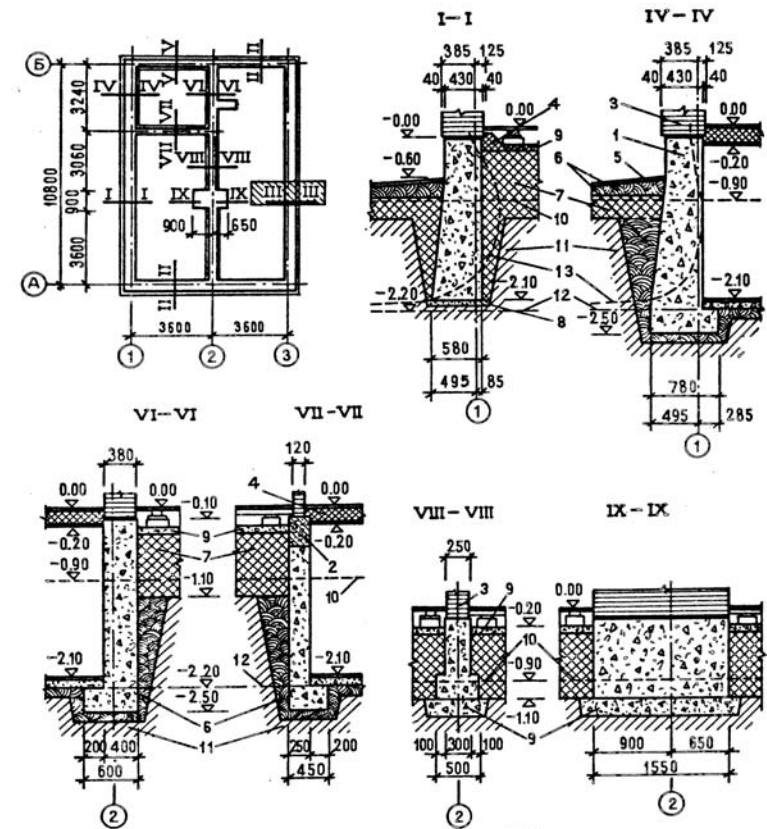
План и сечения ленточных фундаментов: 1 – бетон; 2 – железобетон; 3 – кирпич; 4 – утеплитель; 5 – отмостка; 6 – глина; 7 – насыпной грунт; 8 – песчаная подушка; 9 – песчано-щебеночная подсыпка; 10 – уровень земли до начала строительства; 11 – материковый грунт; 12 – уровень грунтовых вод в период промерзания грунта; 13 – расчетный уровень промерзания грунта (в период эксплуатации дома).
